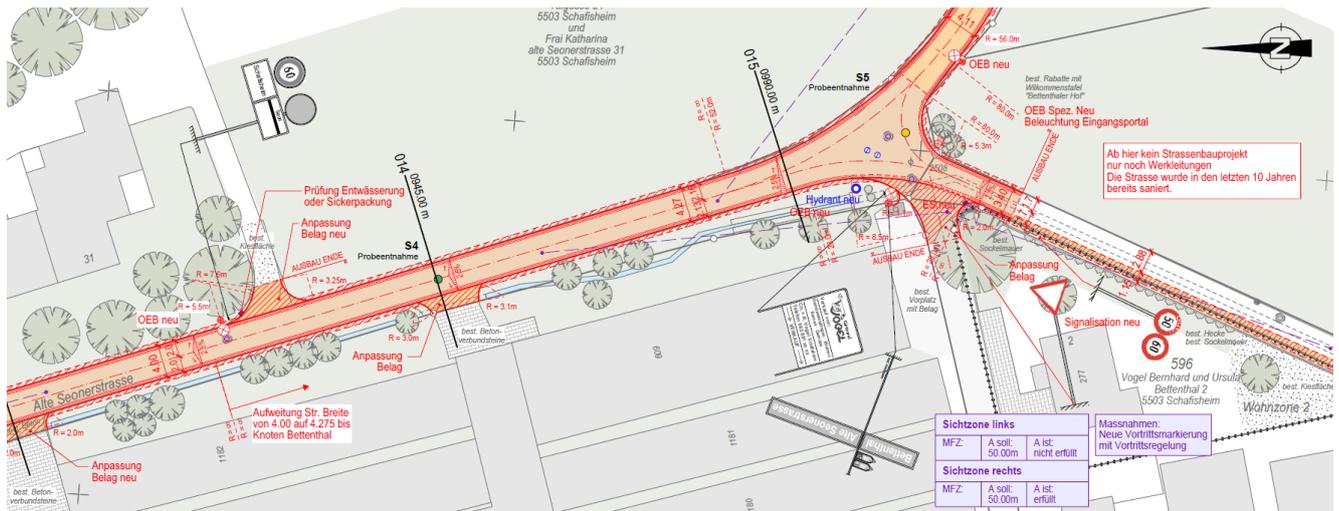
Planausschnitt aus dem Strassenbauplan – Bereich Knoten Bettenthal
